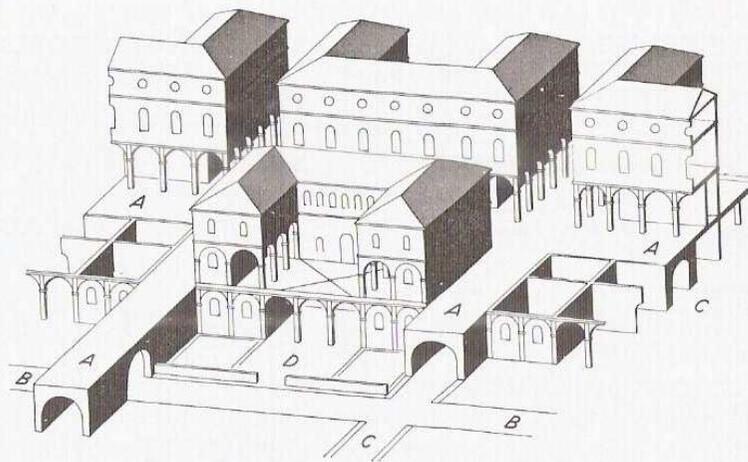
Londres, bairro Adelphi, construído pelos irmãos James e Robert Adam em 1768-72 e demolido em 1937; seção transversal e planta do térreo (segundo S. E. Rasmussen).
